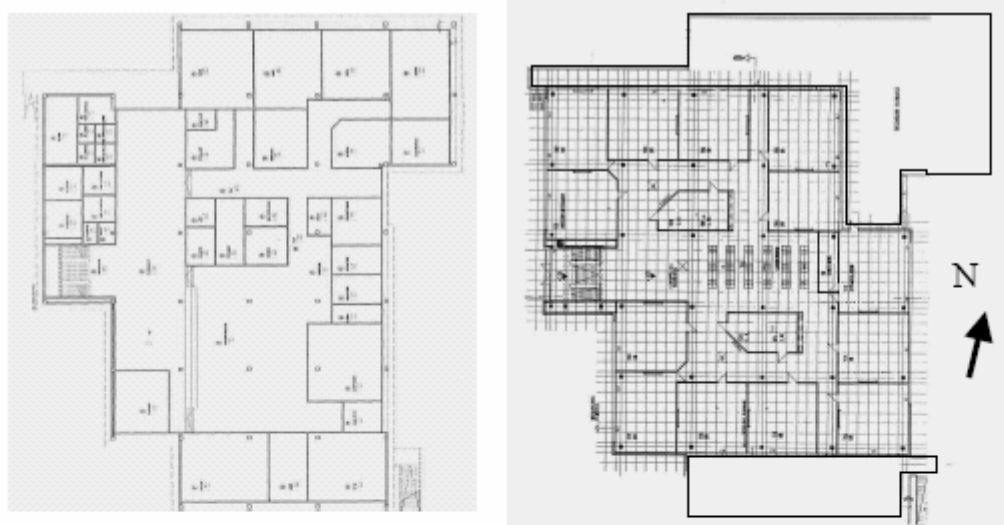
Grundriss Erdgeschoß (links) und 1. Obergeschoß (rechts)
